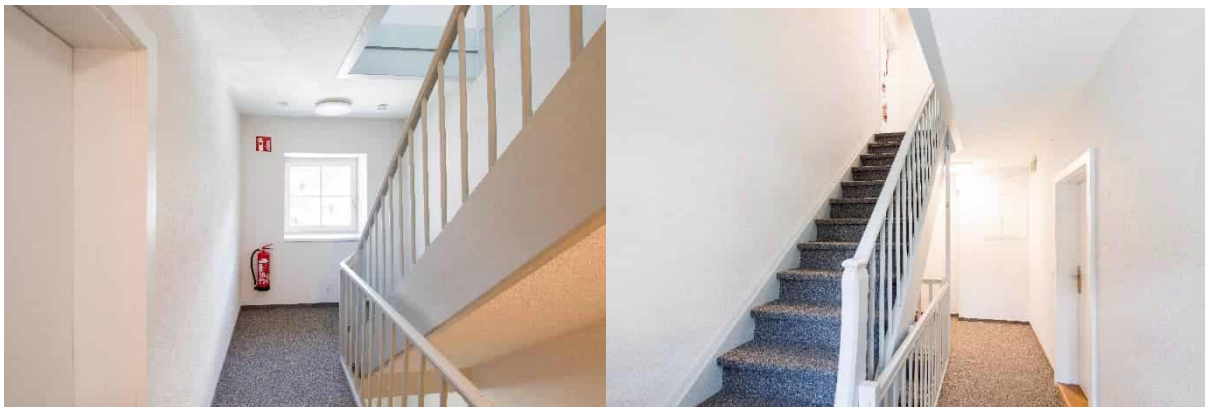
kleines Gebäude: Treppenhaus nach Sanierung, Fotos: Rhomberg Bau GmbH (links); Walser Fotografie
